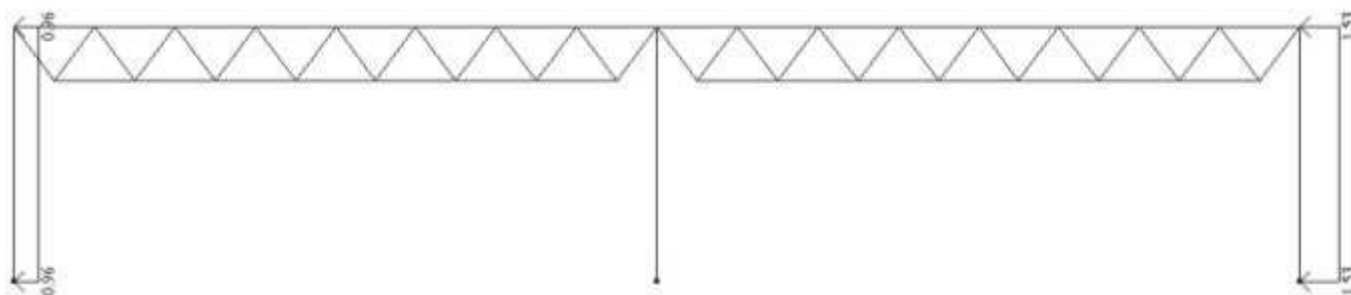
Схема загрузки поперечной рамы ветровой нагрузкой – ветер справа
